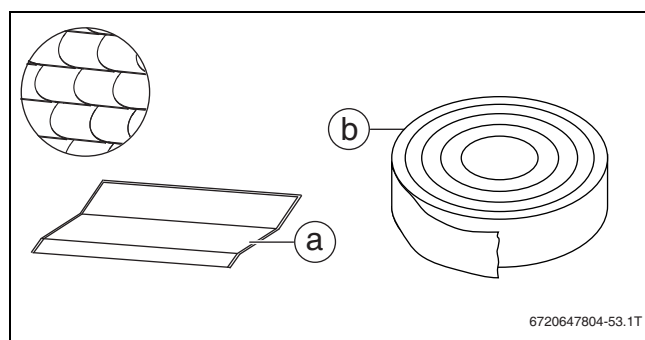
Составные части для покрытия кровли плоским шифером/гонтом
